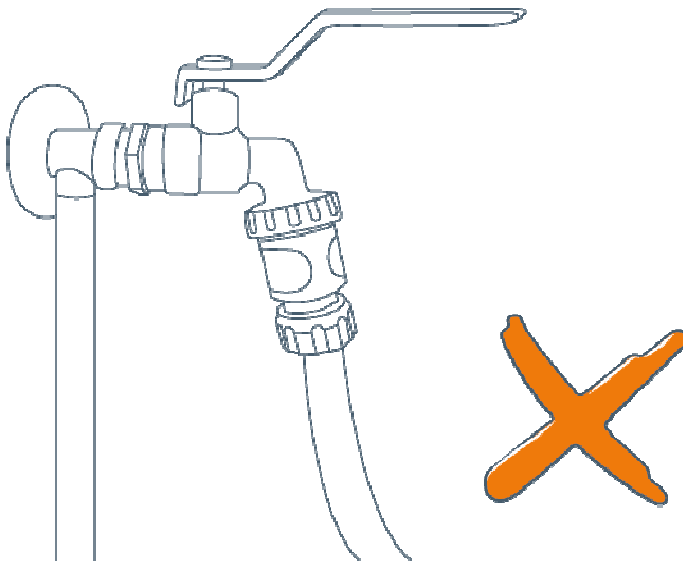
Fehlerhafte Installation: Außenwasserhahn nicht DVGW-zertifiziert
